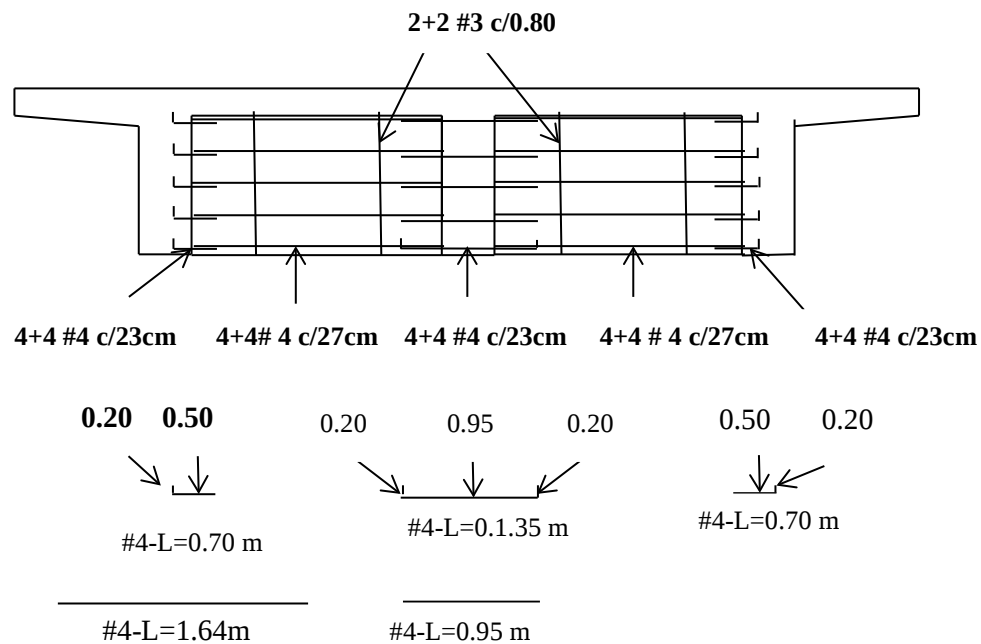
Detalle de armado de la viga diafragma, vista Longitudinal del diafragma.
